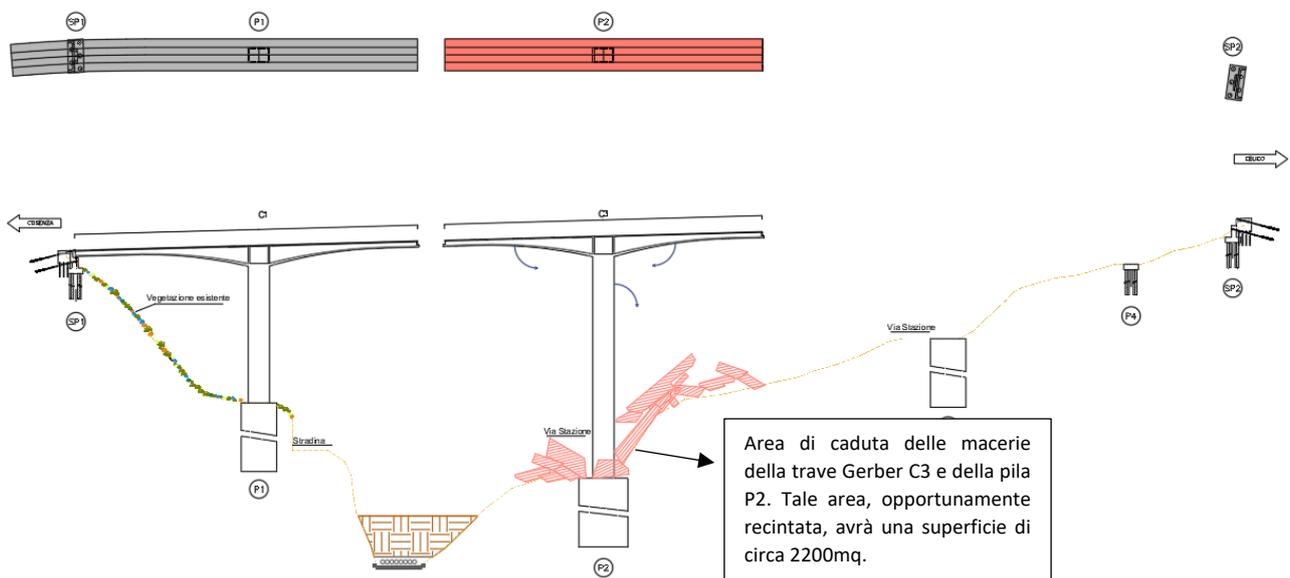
Estratto elaborato V382025002APA “Tavola della fasizzazione dell’intervento di demolizione (4 di 5)”
